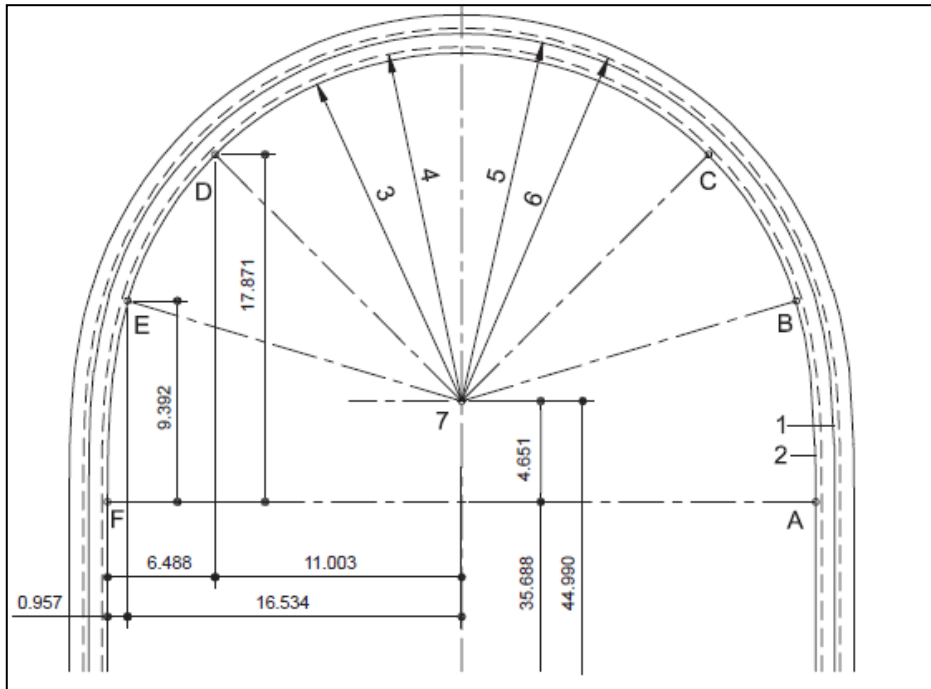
Plan du virage de la piste couverte standard de 200m (dimensions en m)
